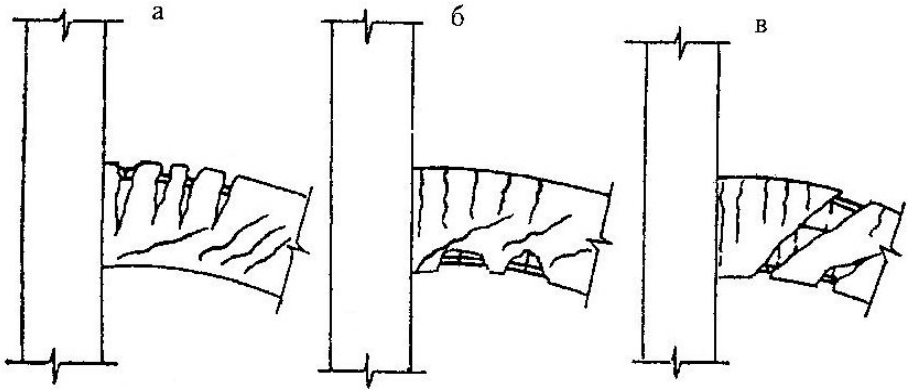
Руйнування залізобетонних балок від зміщення опори:
